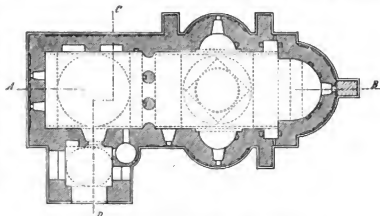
(Mirouts Kirche in Suczawa, Grundriß.)
